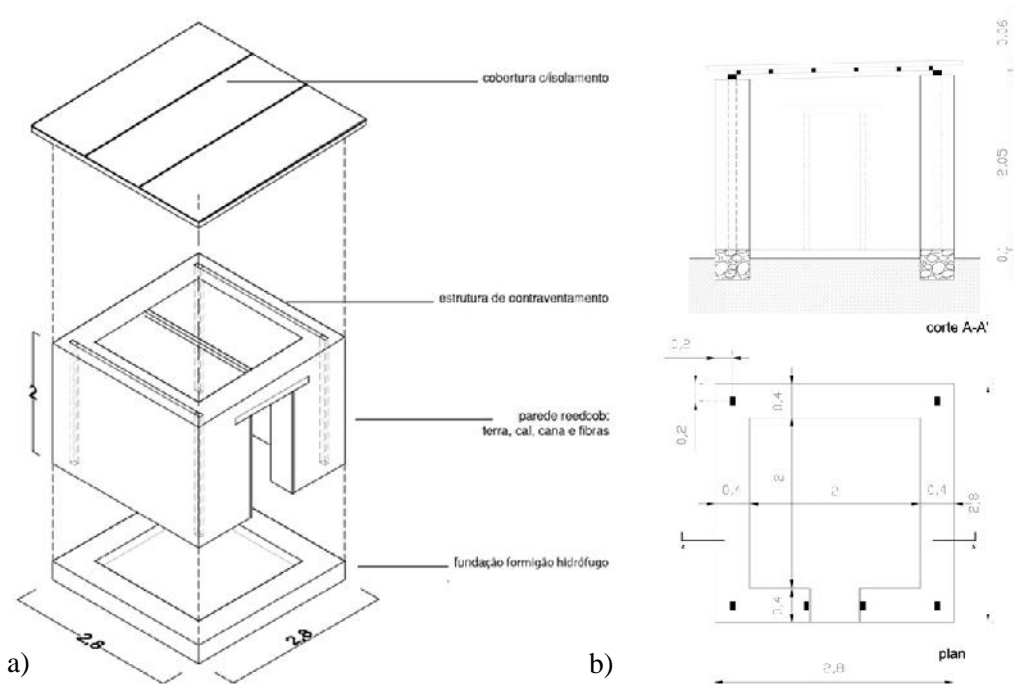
Protótipo 3: (a) Axonometria do sistema construtivo da célula; (b) Planta e corte (unidade: metros)
